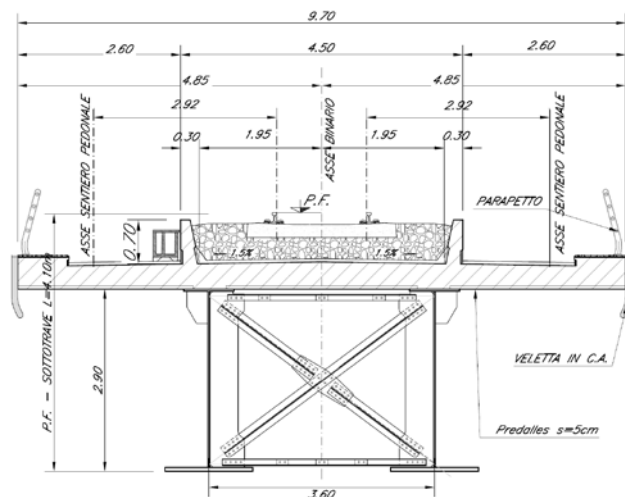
Sezione trasversale campate in acciaio-clc L=40 m
